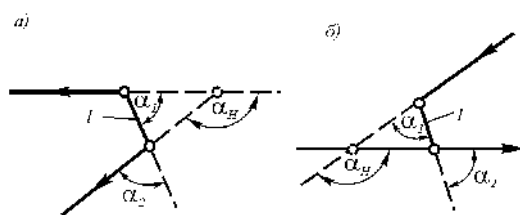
Схемы поворота трубопровода (а) и присоединения боковых веток (б): 1 - дополнительная ветка
